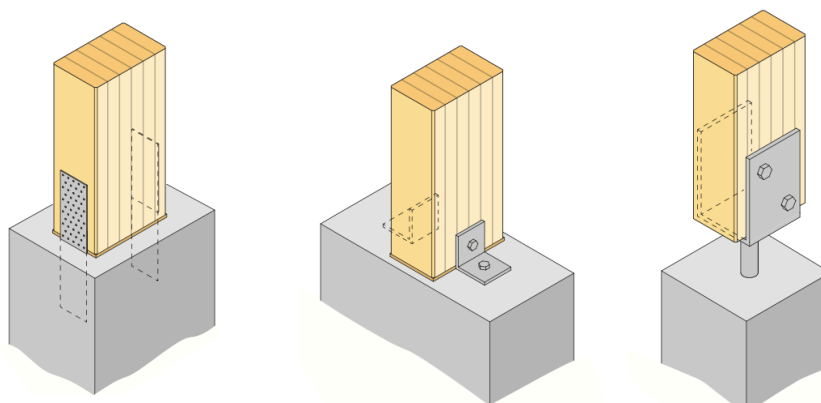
Ligação pilar em GLT à laje a partir de: placa metálica embutida, cantoneira, peça de ferro embutida no pilar.
